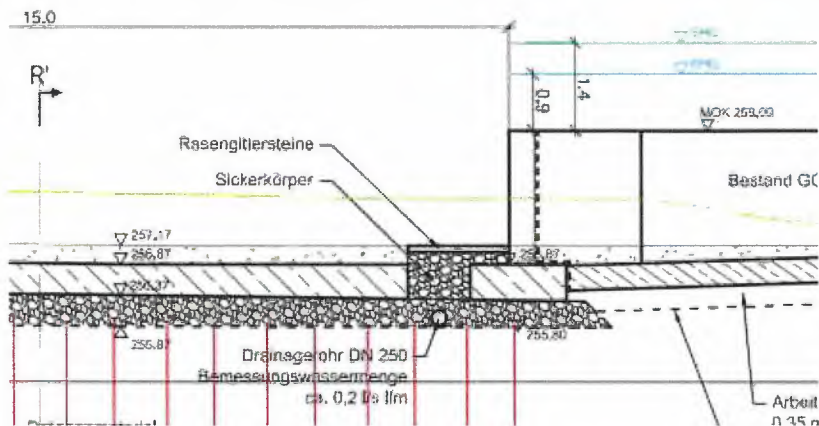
Sickerkörper im Tosbecken; aus Plan 12.5.6
